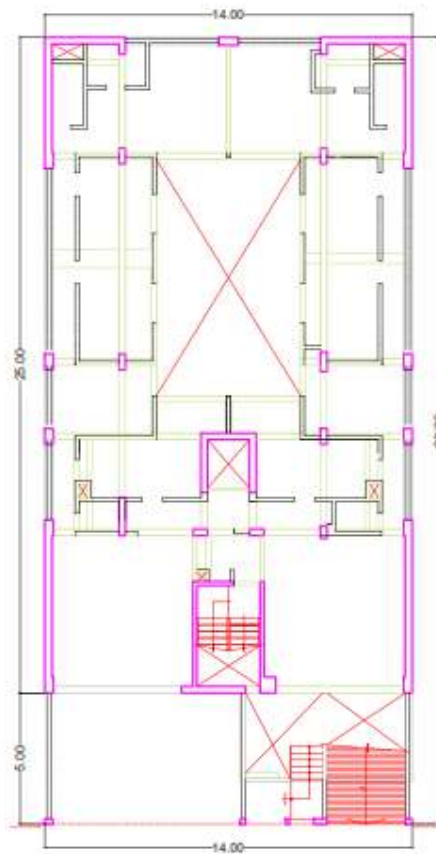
Plano en planta de la estructura, con las dimensiones perimetales y la configuración estructural base.
